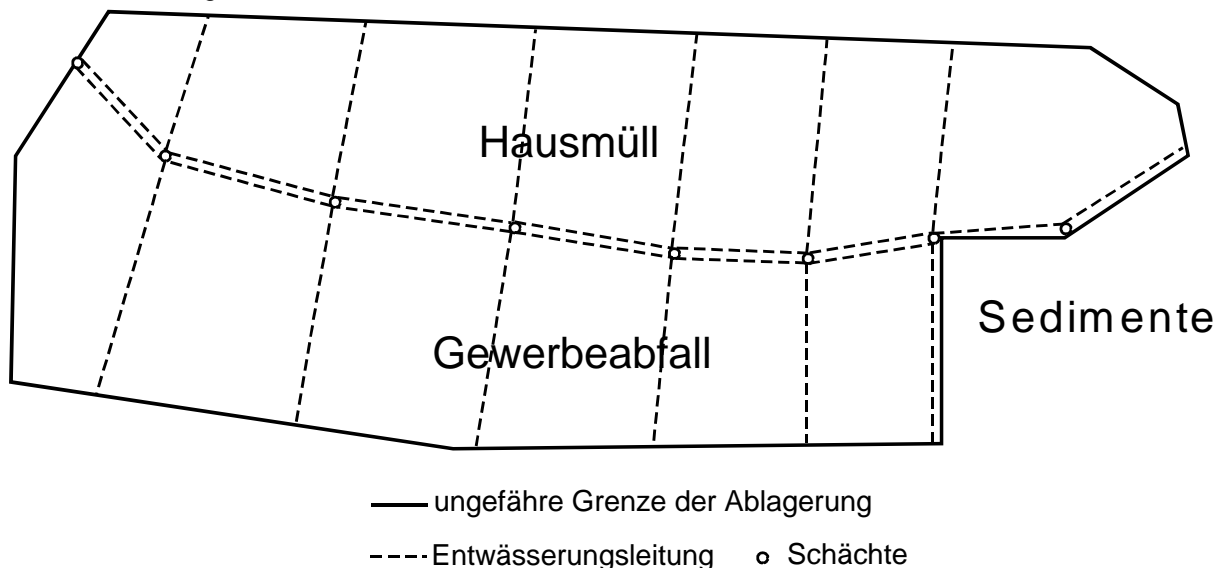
Schematischer Lageplan der Deponie Halle-Lochau mit Darstellung eines Entwässerungssystems, mit dem eine gezielte und kontrollierte Auslaugung möglich ist (Erläuterungen s. Text)
